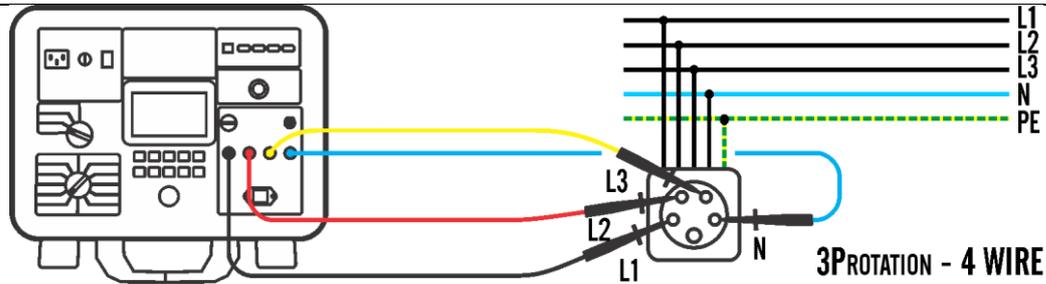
Collegamento a 4 fili per la misura della rotazione di fase, esempio.
